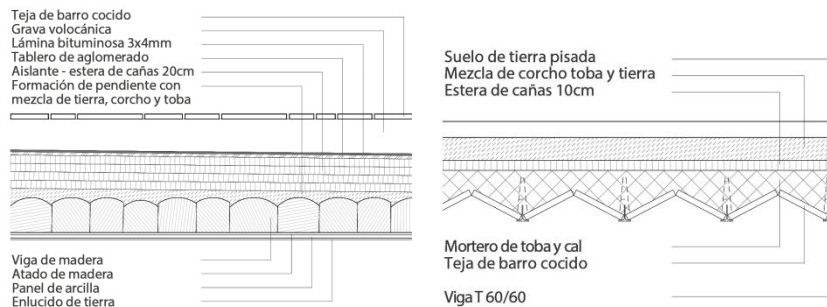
Detalles cubierta y forjado de la cocina. Fuente: Martin Rauch
